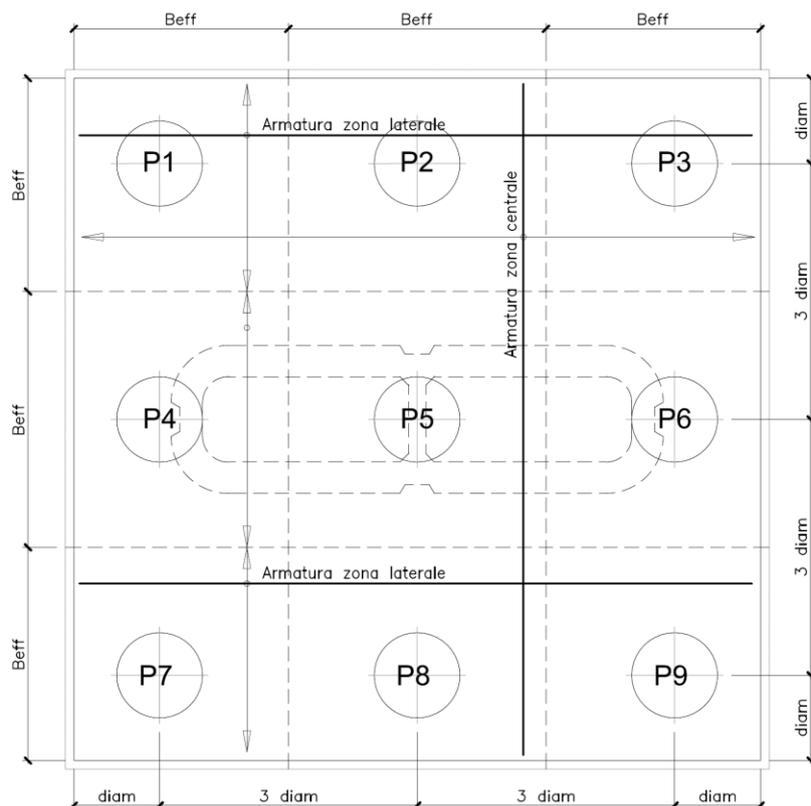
Plinto di fondazione – Armatura longitudinale inferiore e superiore
